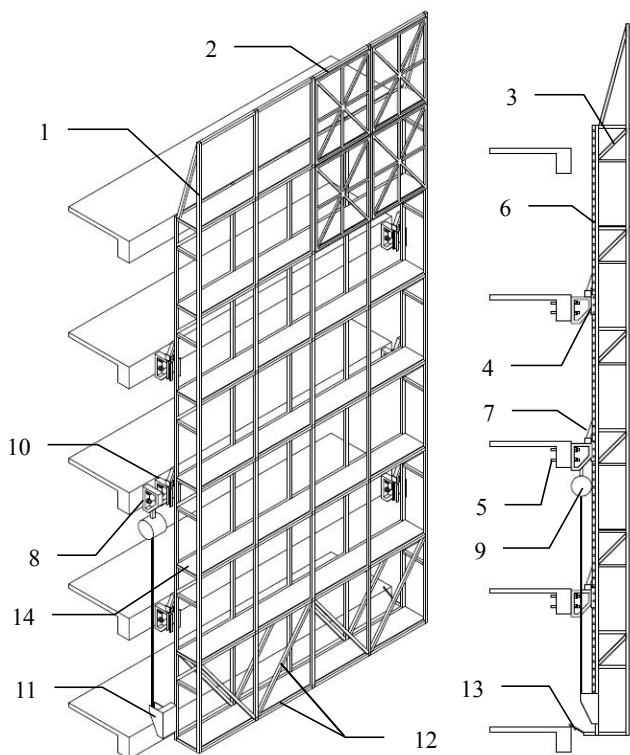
常见侧提升式附着升降脚手架示意图
